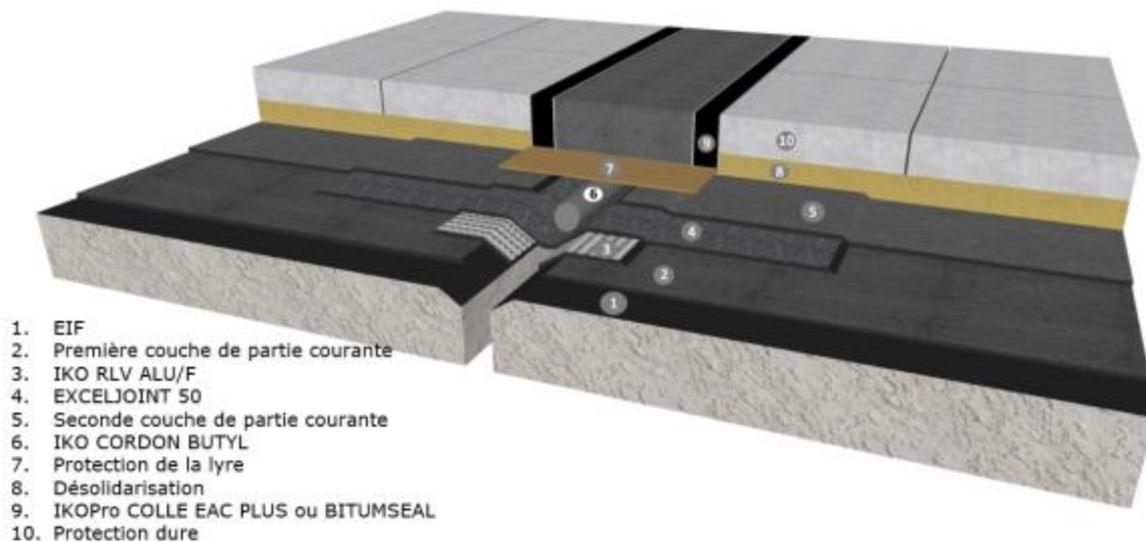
Joint plat en partie courante raccordé à une étanchéité en bitume modifié, en terrasse accessible aux piétons
